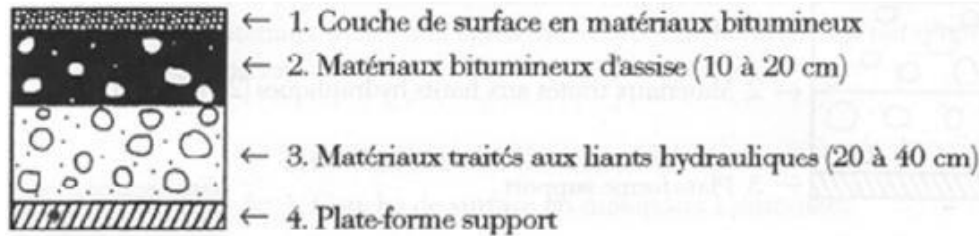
8 Exemple de la chaussée à structure mixte [9].
